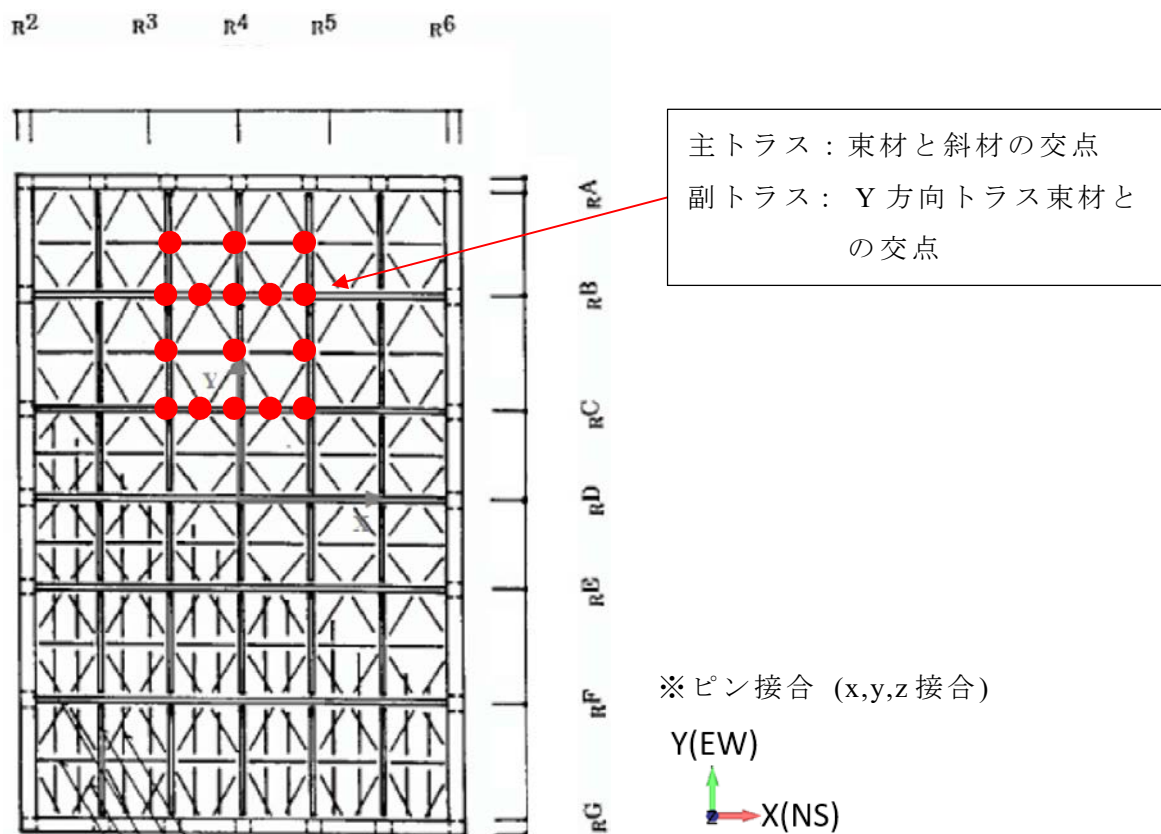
屋根スラブと屋根トラスの接合位置（赤丸）の例
